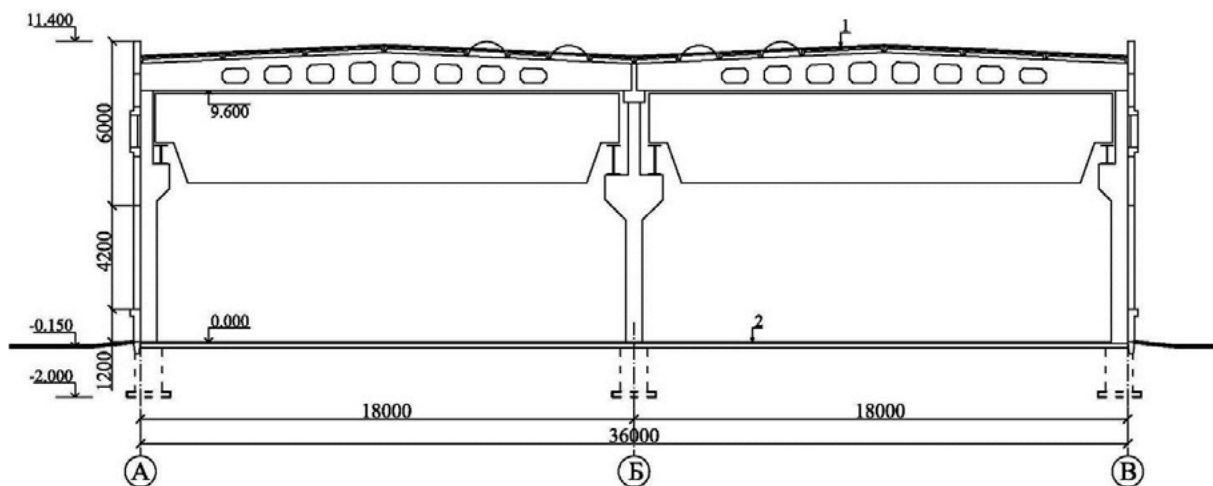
Пример поперечного разреза производственного здания с железобетонным каркасом:
